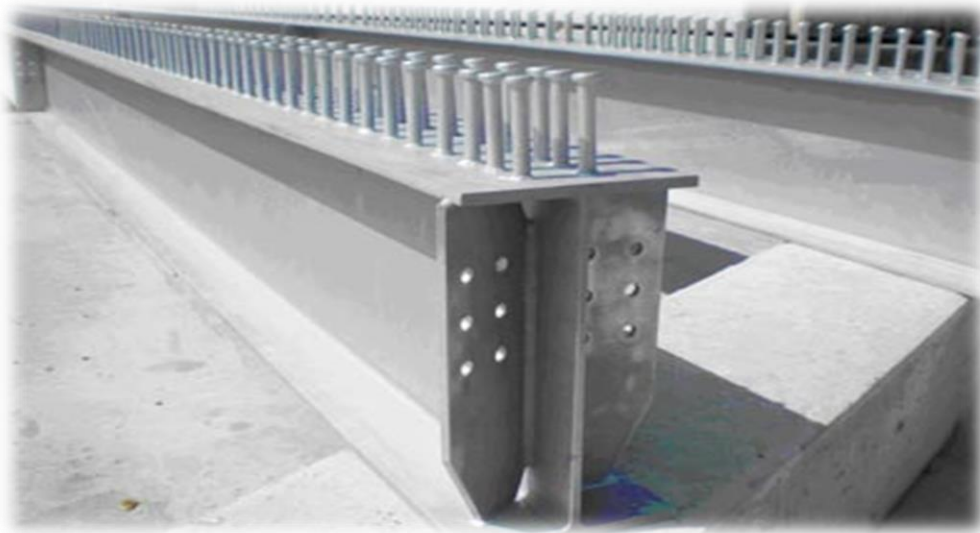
Files de goudons soudés sur la semelle supérieure d'une poutre
